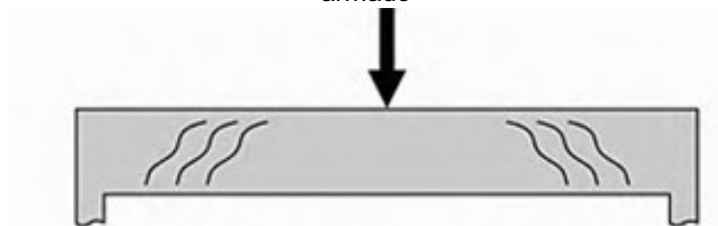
Fissuras devido aos esforços de flexão
